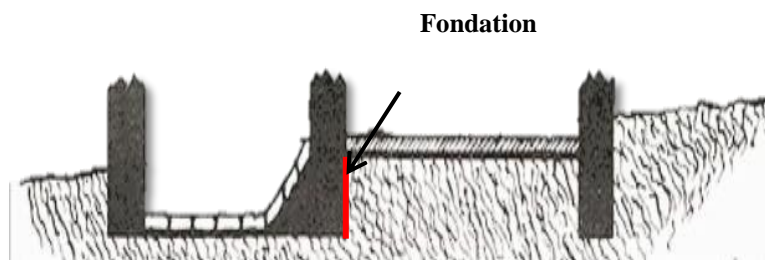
Coupe schématique des fondations d'une maison traditionnelle kabyle
